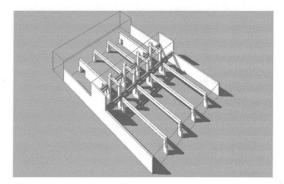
Las dos vigas de arriostrado de los seis planos constructivos principales (Dibujo del autor)
